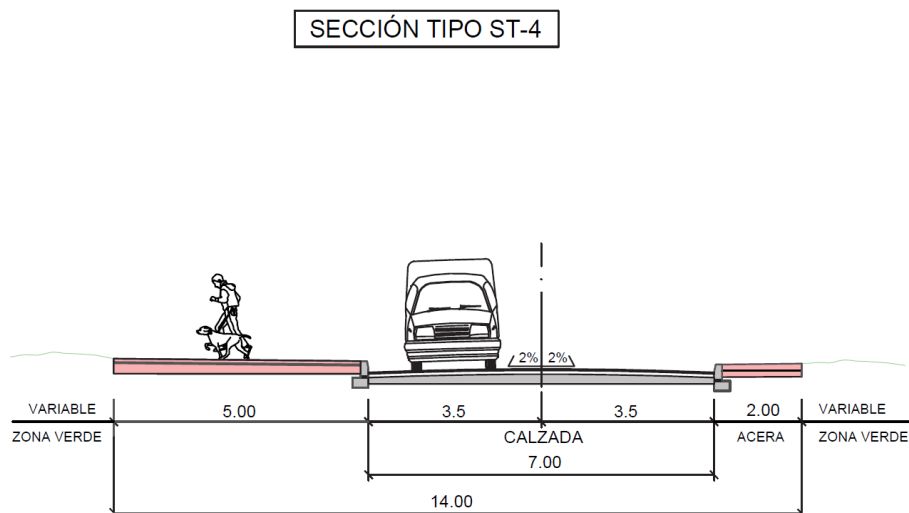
Sección Tipo ST-4 del campus de la UA. Elaboración propia.
